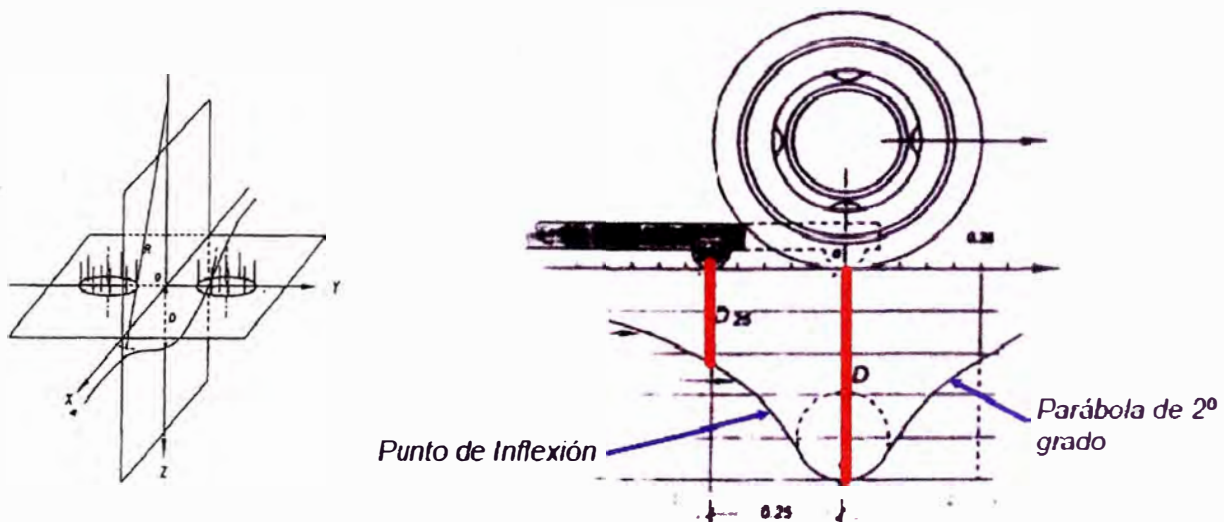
Deformada del pavimento y parámetros de comparación.
